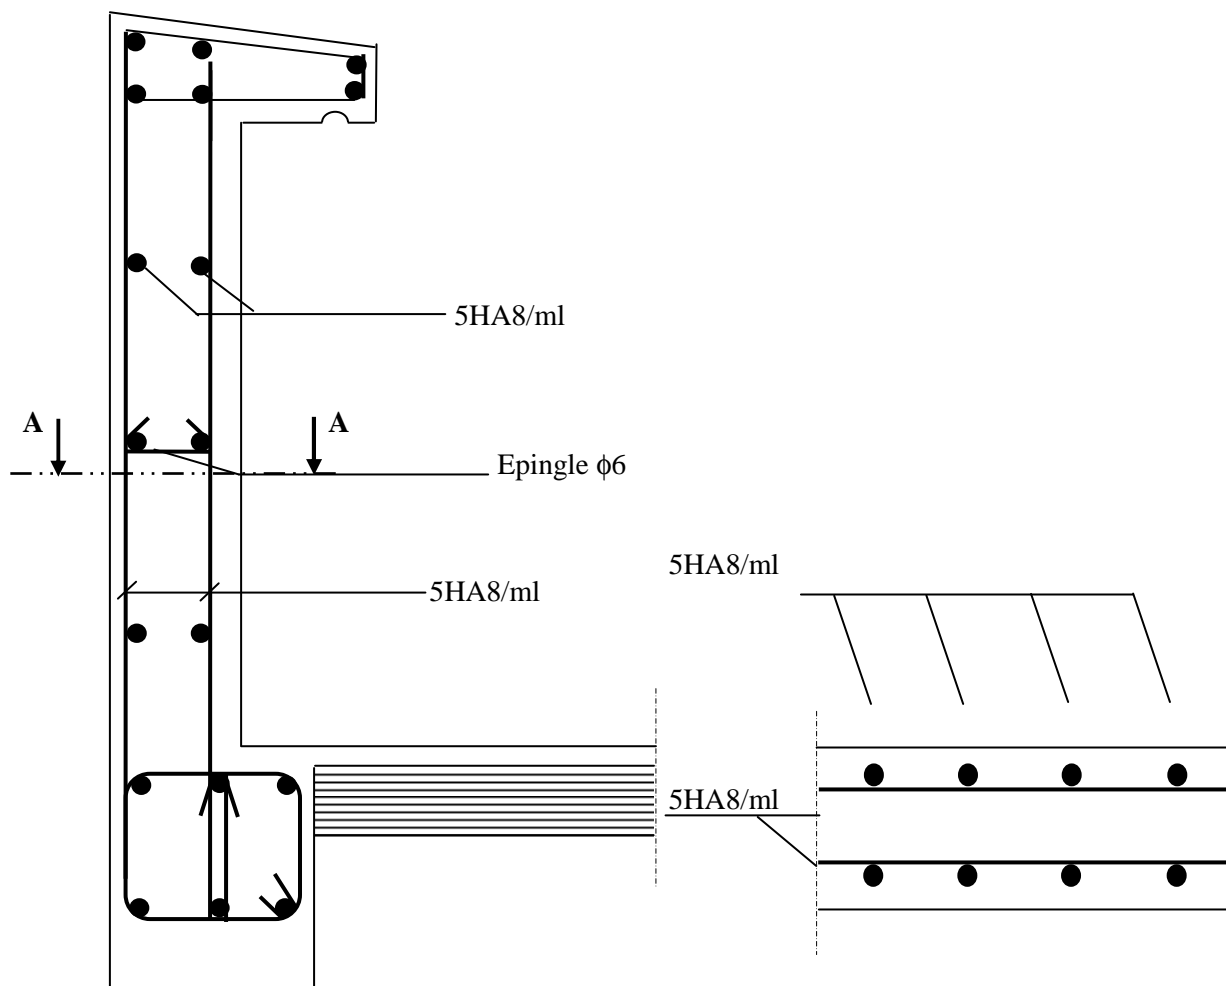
Plan de Ferrailage de l'acrotère.
